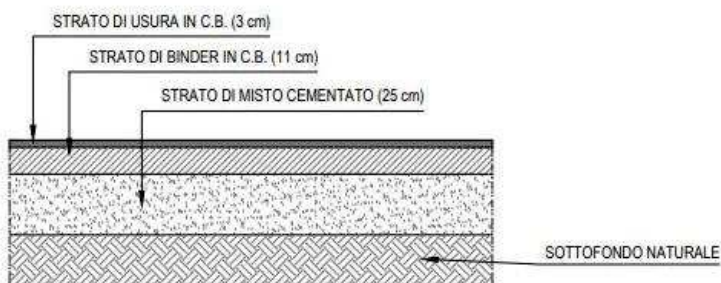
Dettaglio pavimentazione ciclabile in conglomerato bituminoso
